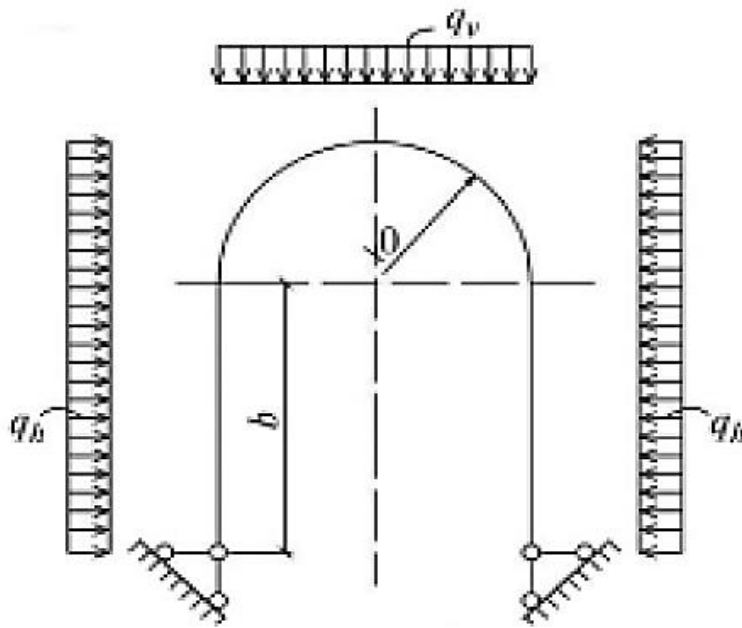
Розрахункова схема та навантаження у разі відсутності відсічі породи
